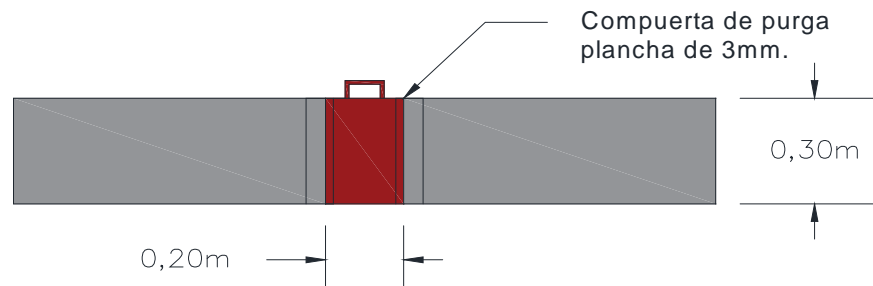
Detalle compuerta de purga en el canal Tárraga.
